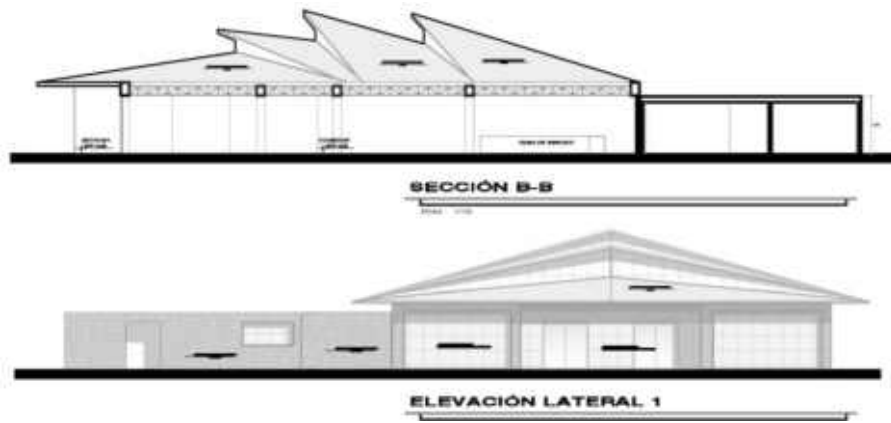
planta y secciones de bloque de comedor, fuente elaboración propia.
